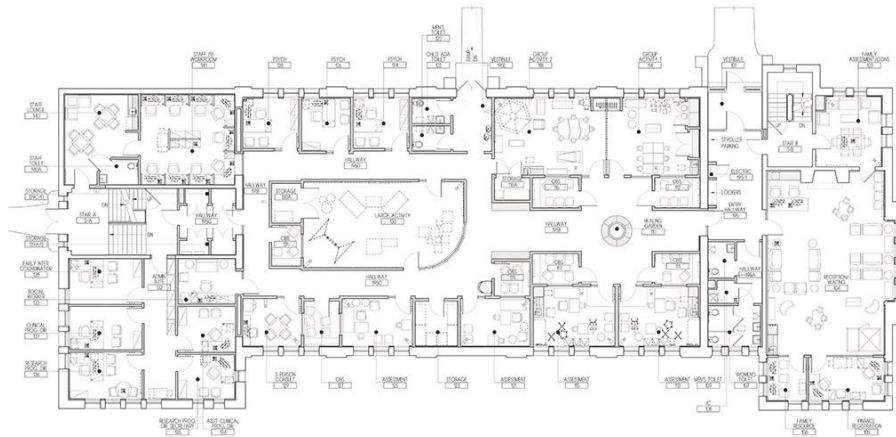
Planta do Centro de Autismo e Cérebro em Desenvolvimento
